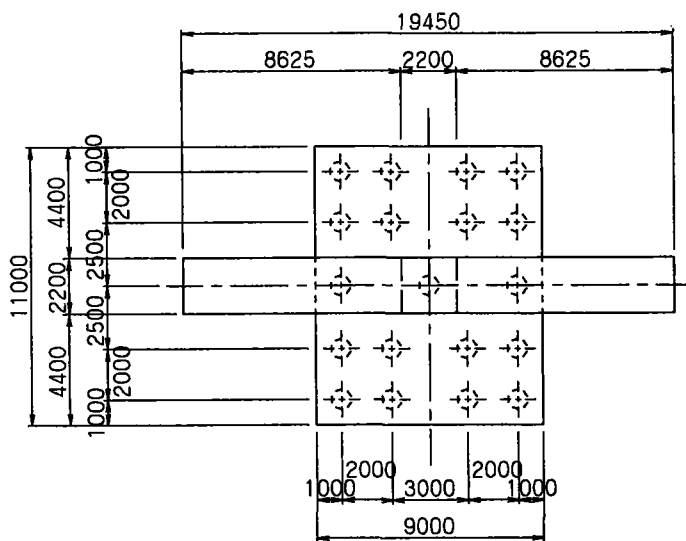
設計対象橋梁(資料の図-4.2.2を引用)
